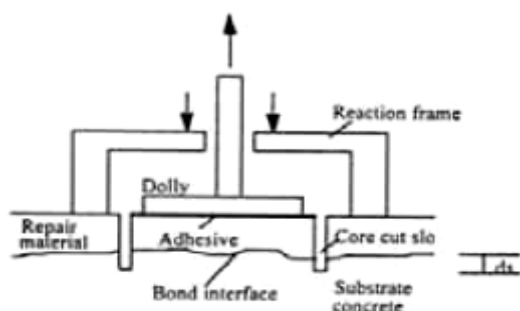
Dispositif d'essai in situ [B POUTEAU 2004]
